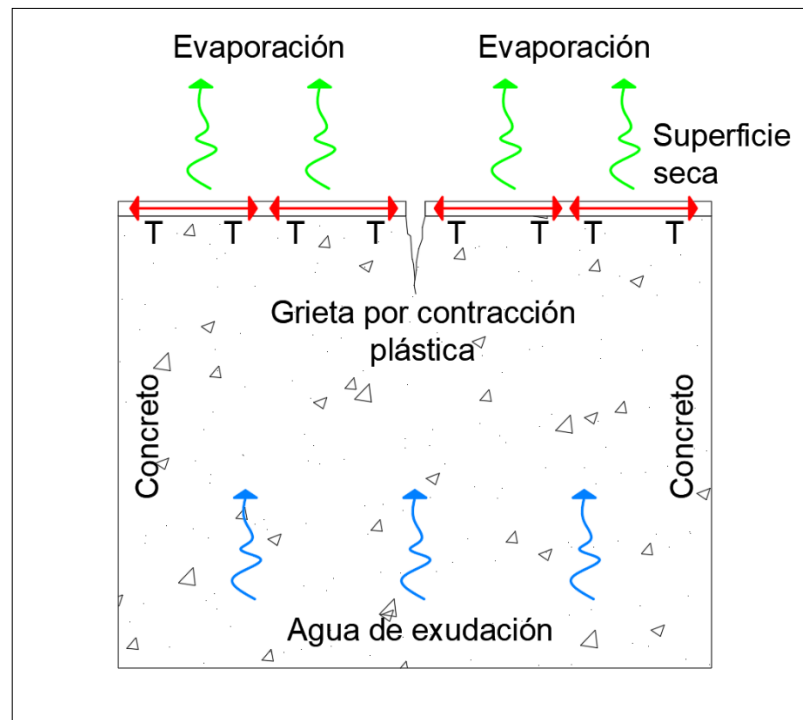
Mecanismo de generación de grietas por contracción plástica.
